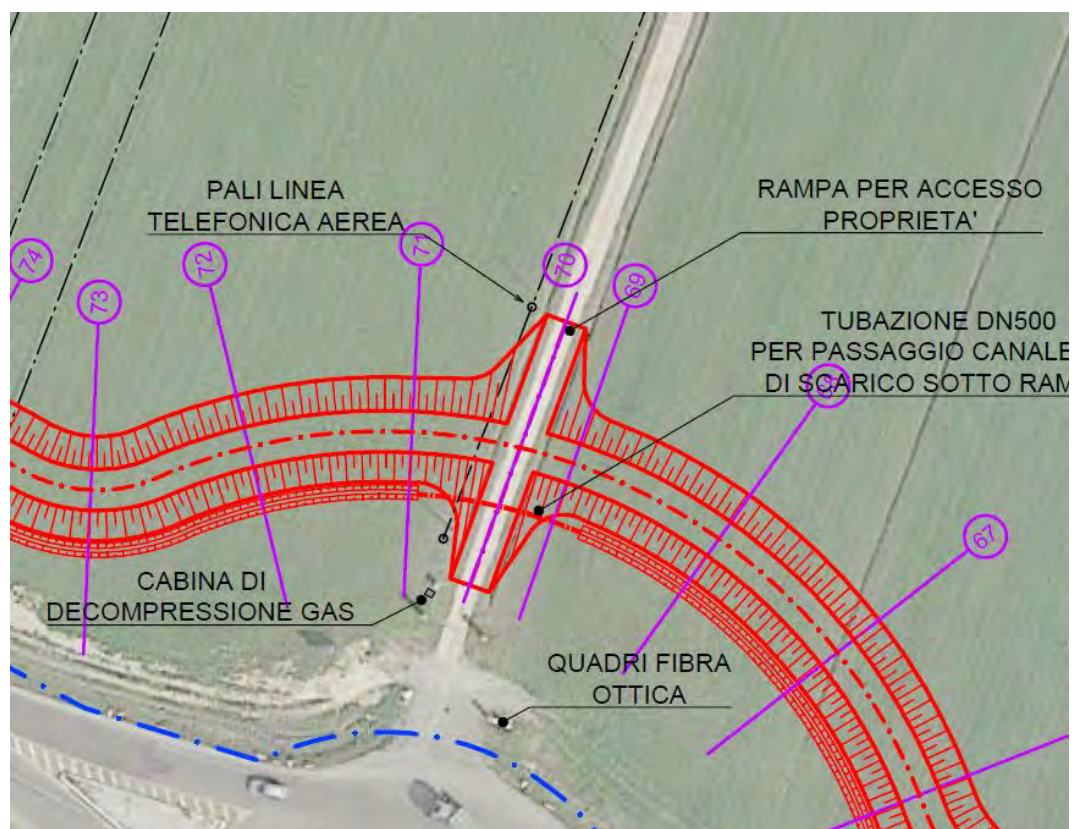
posizione linea telefonica aerea e pali di sostegno, gas e fibra ottica (stralcio planimetria di progetto).
